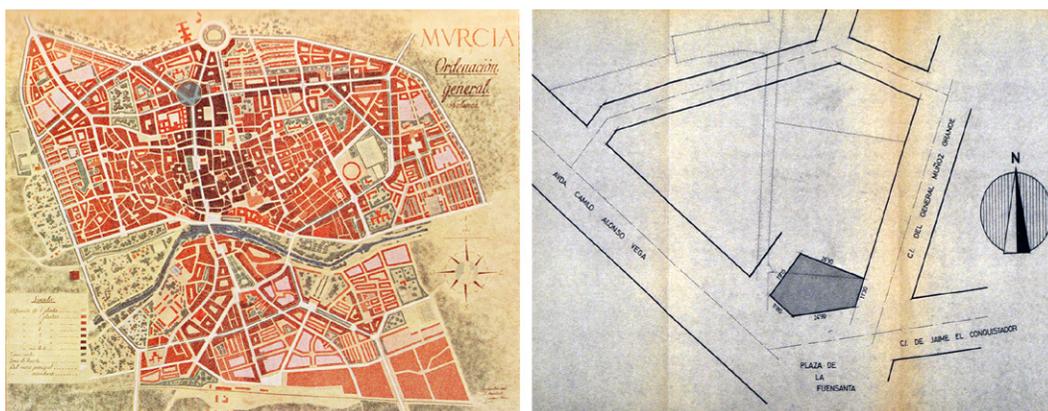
/ Plano de Murcia de Gaspar Blein de 1949 con el trazado definitivo de la Gran Vía donde se ha marcado con un círculo gris el emplazamiento de la obra (izquierda). Plano de situación del edificio 'Vitalicio' de Escario-Vidal-Vives (EVV), 1968 (derecha)
